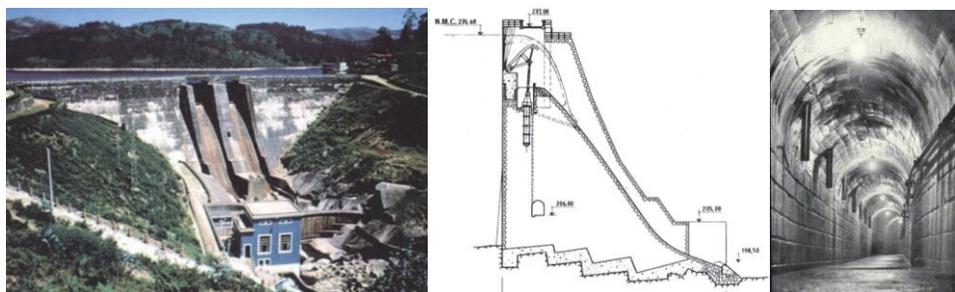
Vista de jusante e corte transversal da barragem de Guilhofrei e galeria de drenagem da barragem com seção 2,0 m x 2,5 m (capa da Revista Técnica 179, janeiro 1948).
